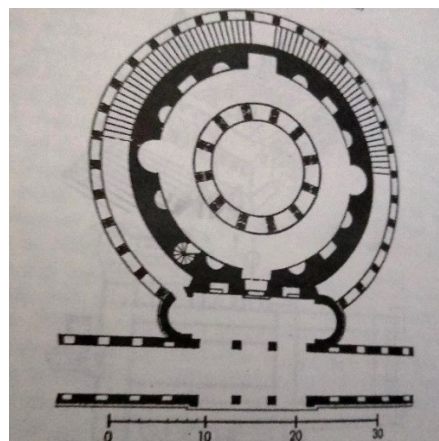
Planta da Basílica de Santa Constança em Roma.³³
